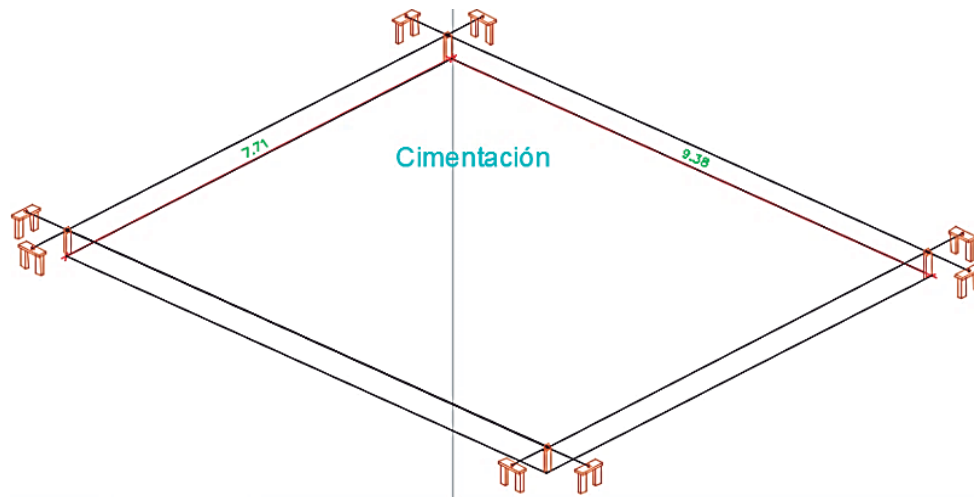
Replanteo de cimentación en un área de 72,32m² - AutoCAD, 2018
